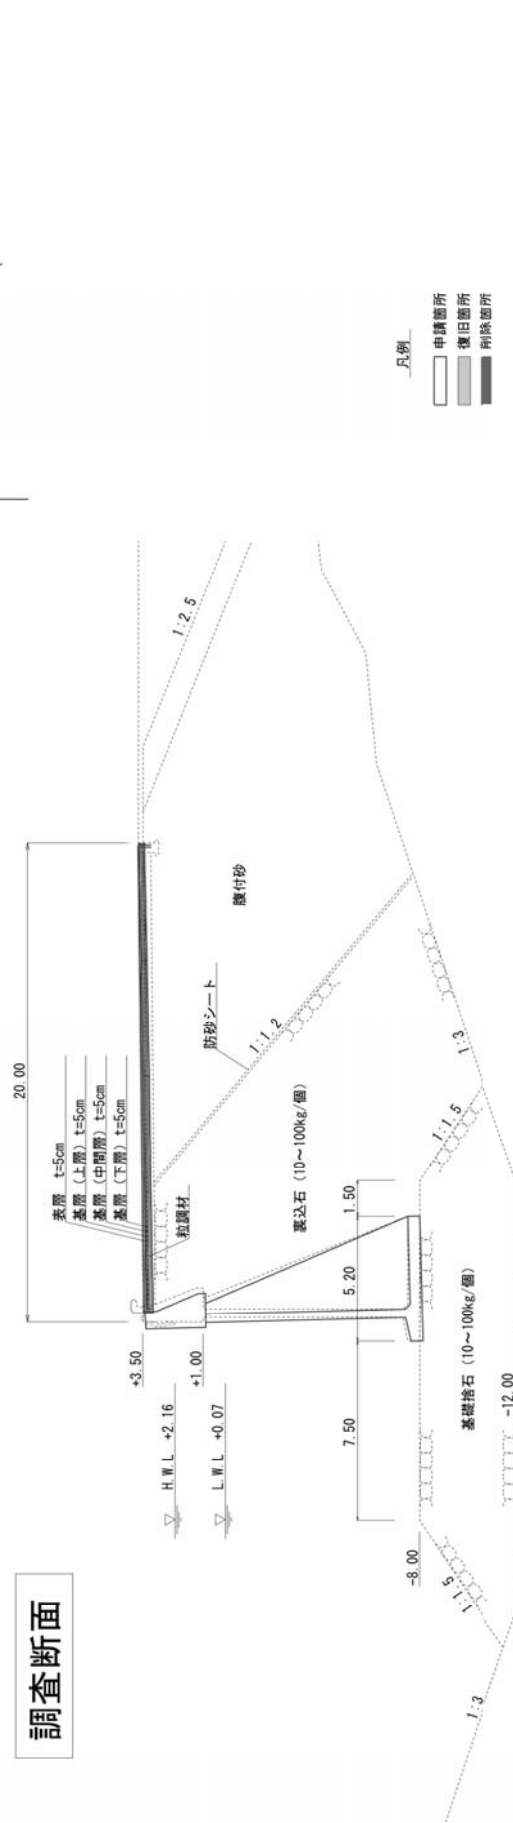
(b) 香椎パークポート地区-7.5m岸壁の復旧後平面図
